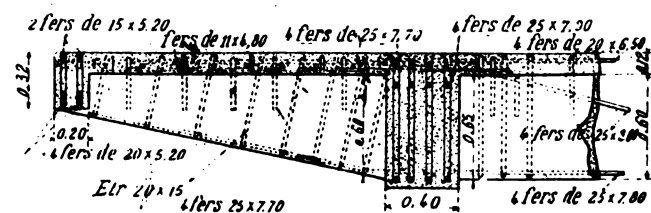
Coupe de l'encorbellement entre les poutres intermédiaires.
